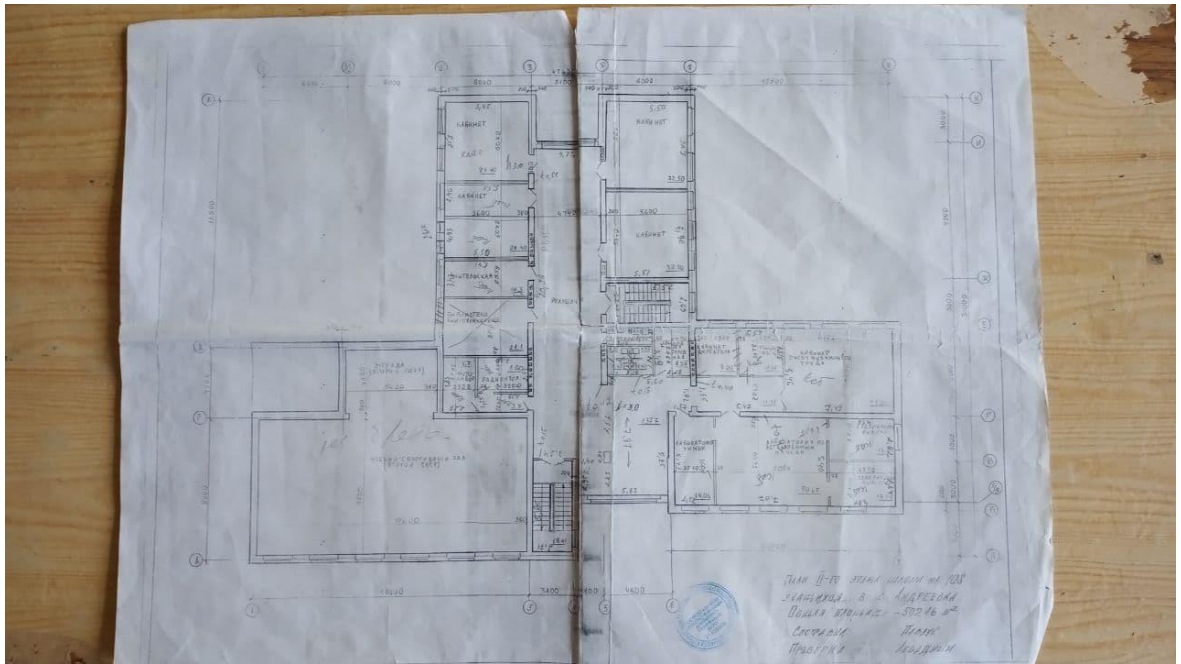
План будівлі 2-го поверху Андріївського ліцею.
